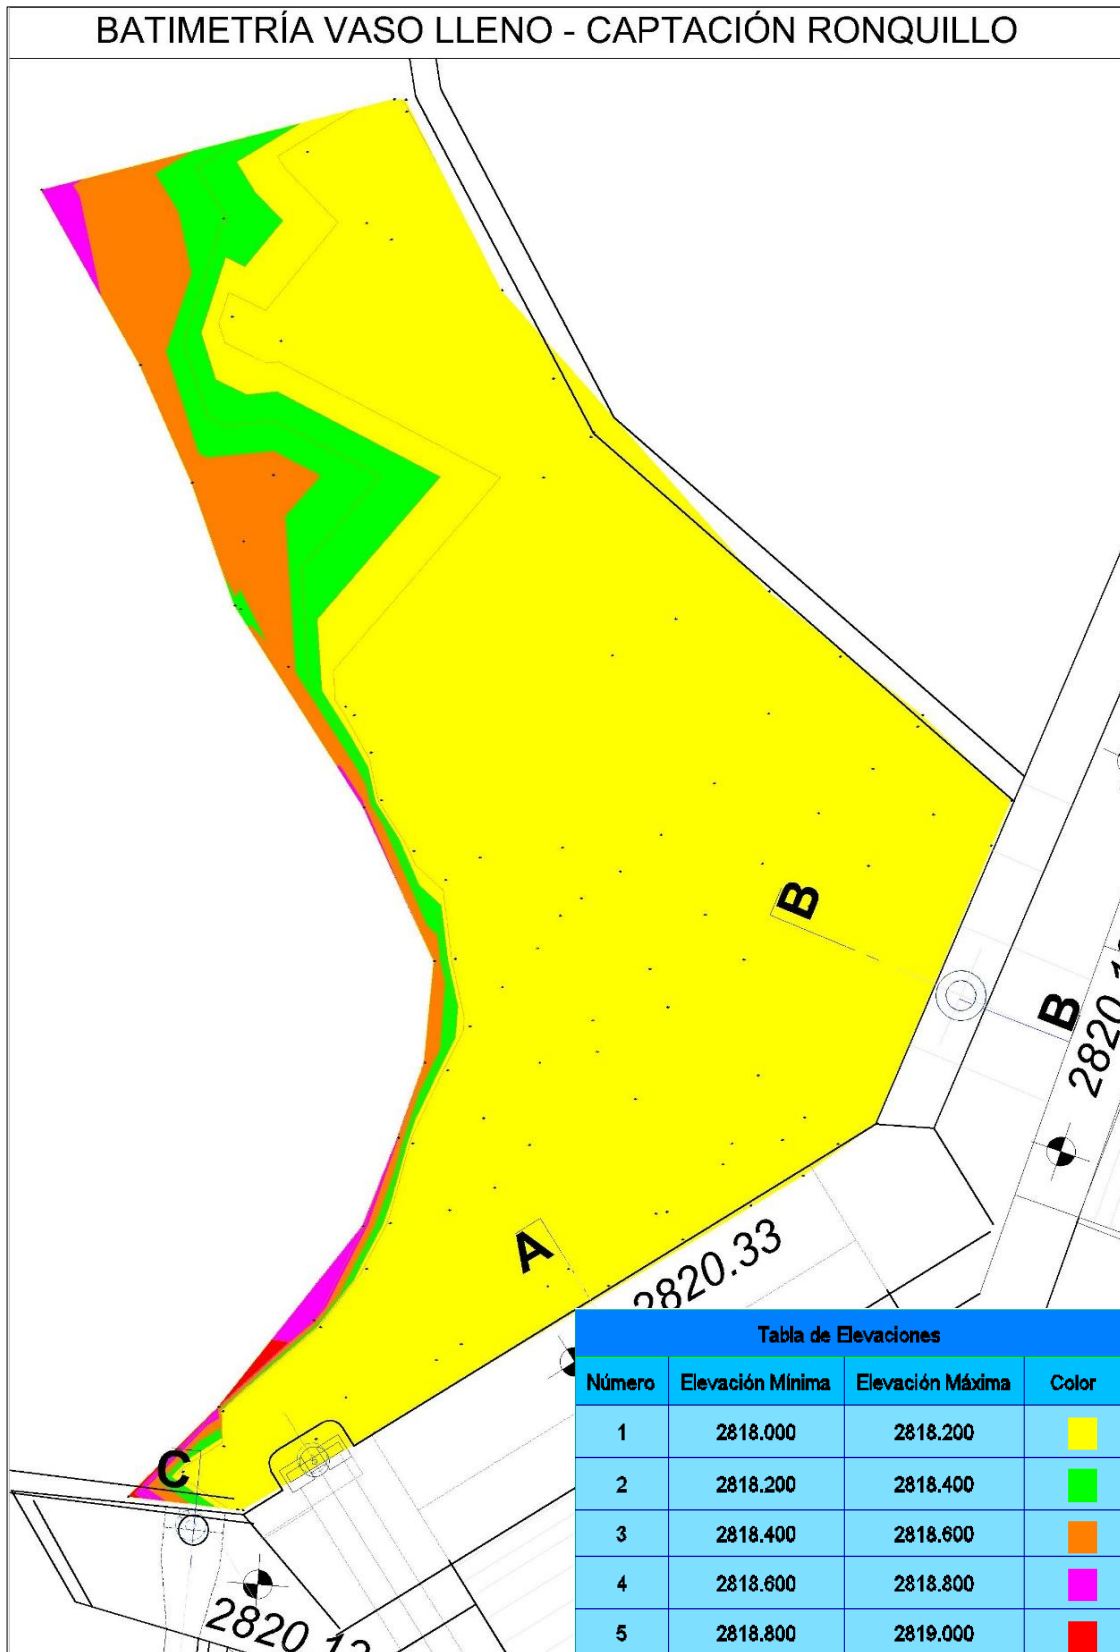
Vista en planta de batimetría de vaso de presa lleno.
